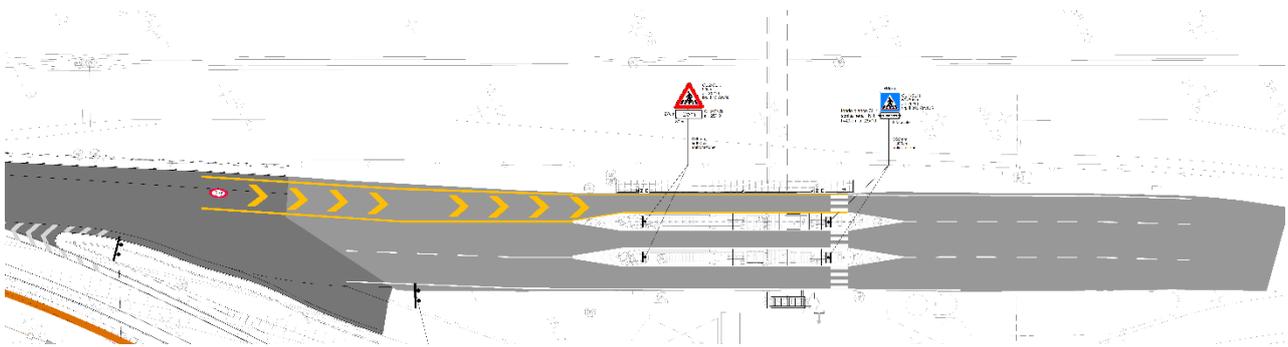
Pianta dei varchi di progetto in entrata A13
